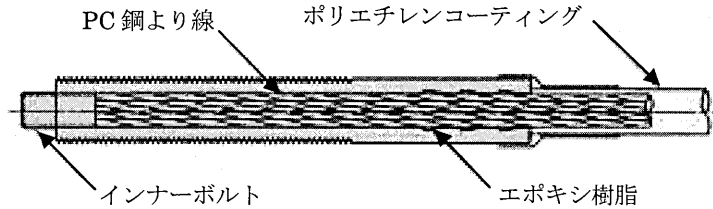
工場製作タイプPCケーブルの端末金具例
